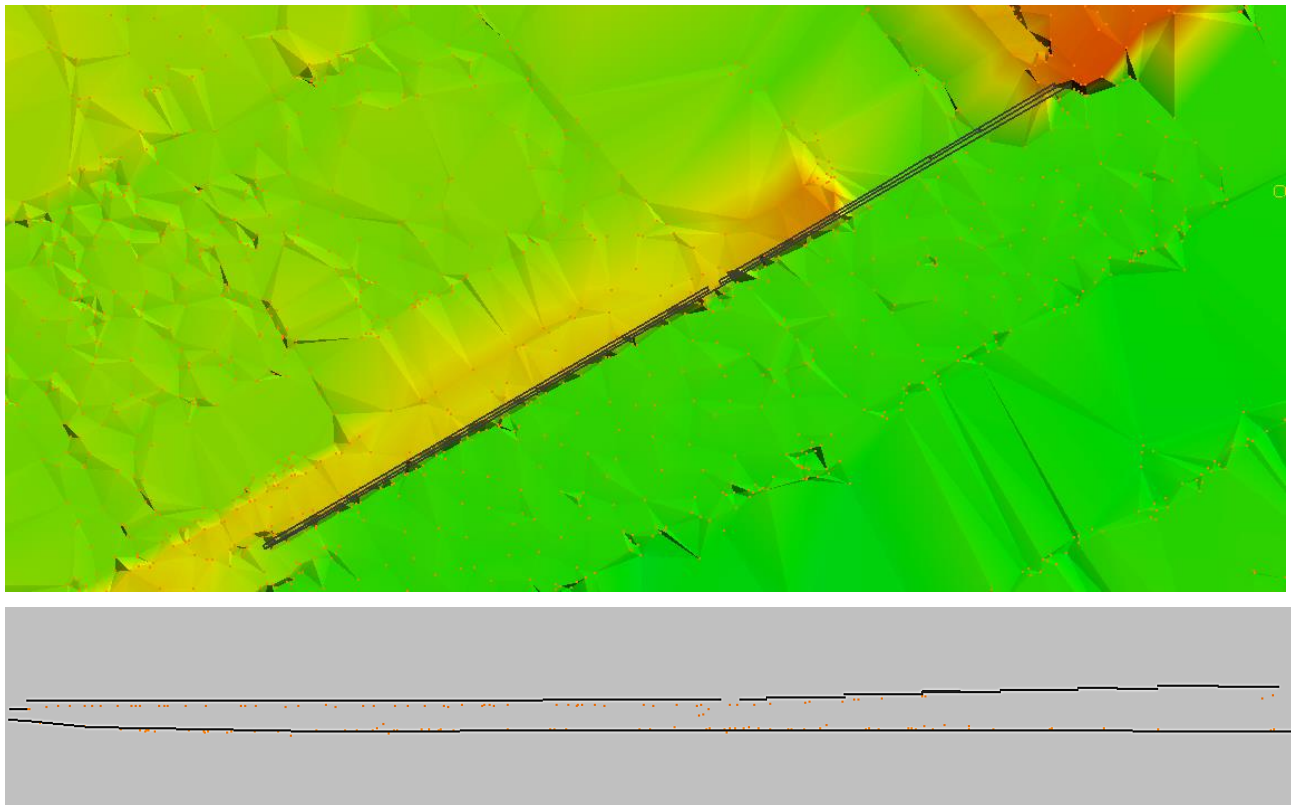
Muro rilevato in via Spalti del Re in planimetria e in sezione (punti arancio: rilievo LiDAR).
